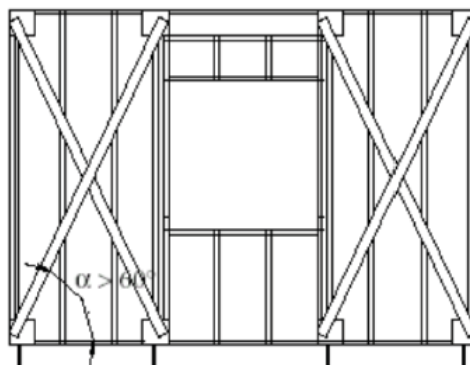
PAINÉIS DO SISTEMA LSF.
